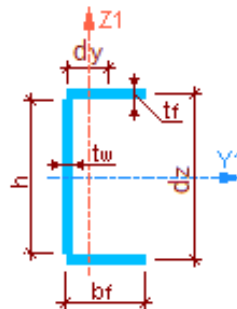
Схема профиля Швеллер сварной
